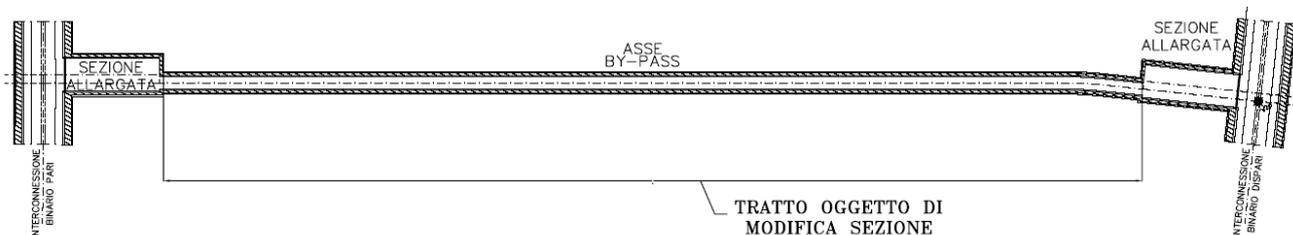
Schema planimetrico del tratto oggetto di modifica di sezione
